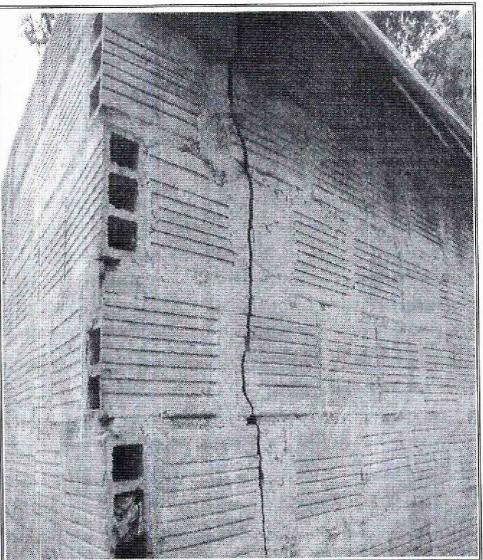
Vista grietas en muro perimetral construcción 1 afectada por el incendio, Corregimiento de Betania Vereda el Raizal Localidad de Sumapaz
